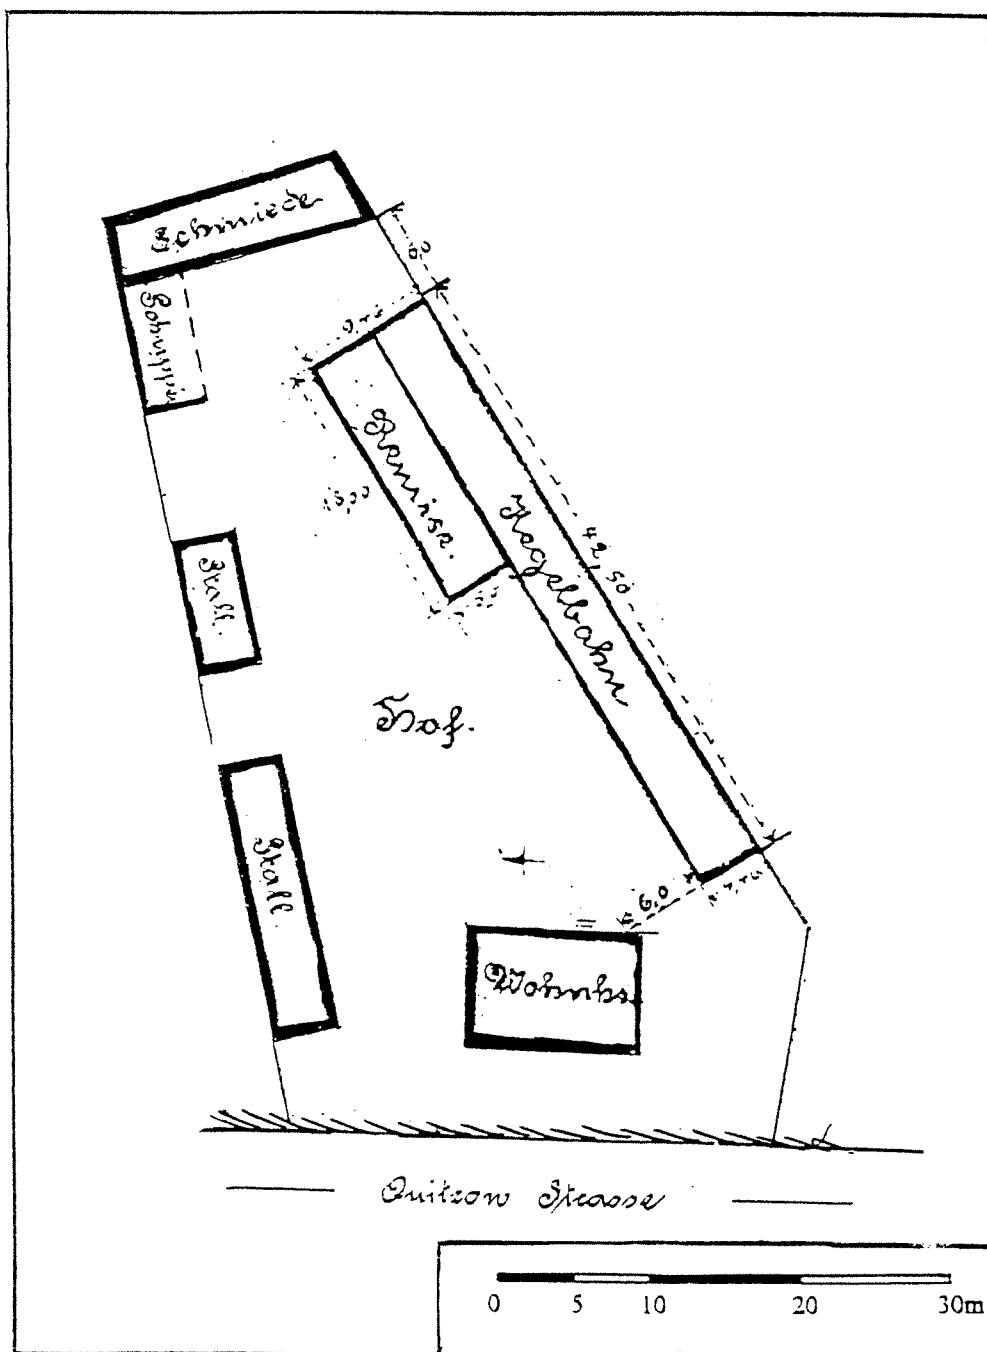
a : Verdachtsfläche 4 - Bebauungssituation 1898
